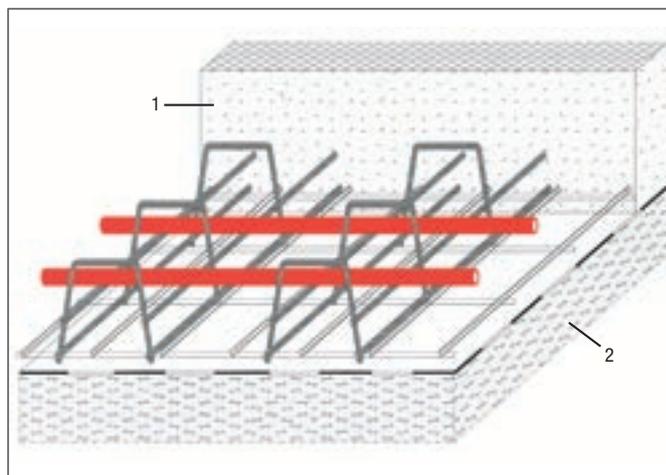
Piano di fondazione in cemento armato con fibre d'acciaio; costruzione standard con tubi di riscaldamento montati sulla rete di armatura inferiore
